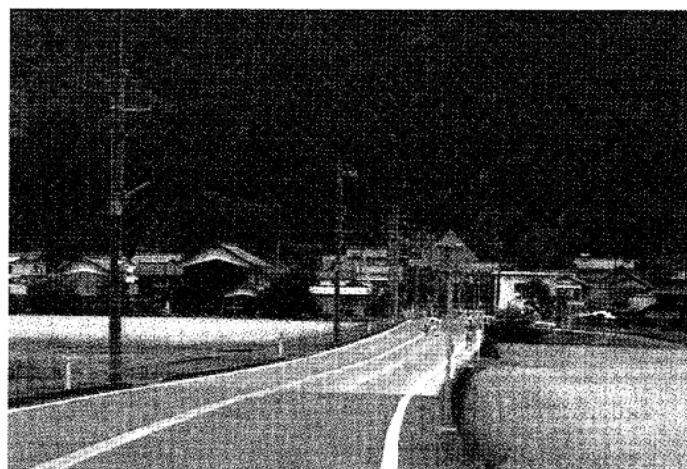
今立の試験舗装の施工場所状況(手前が a タイプおよび奥が b タイプ)
